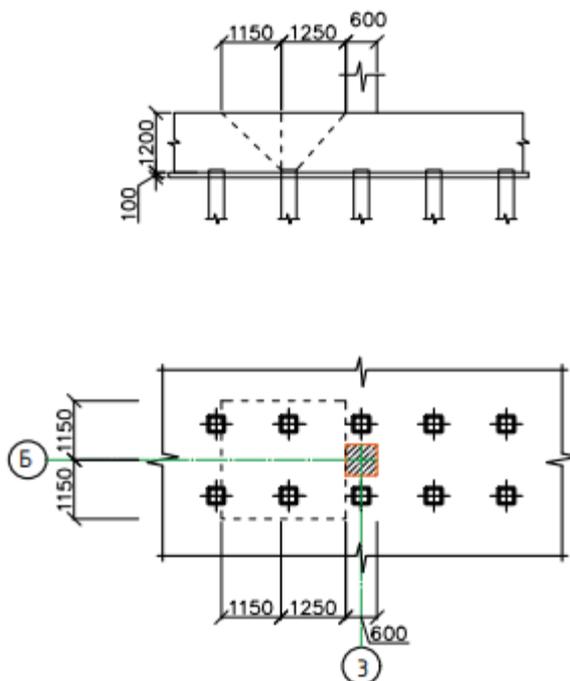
Схема к расчету плитного фундамента на продавливание
